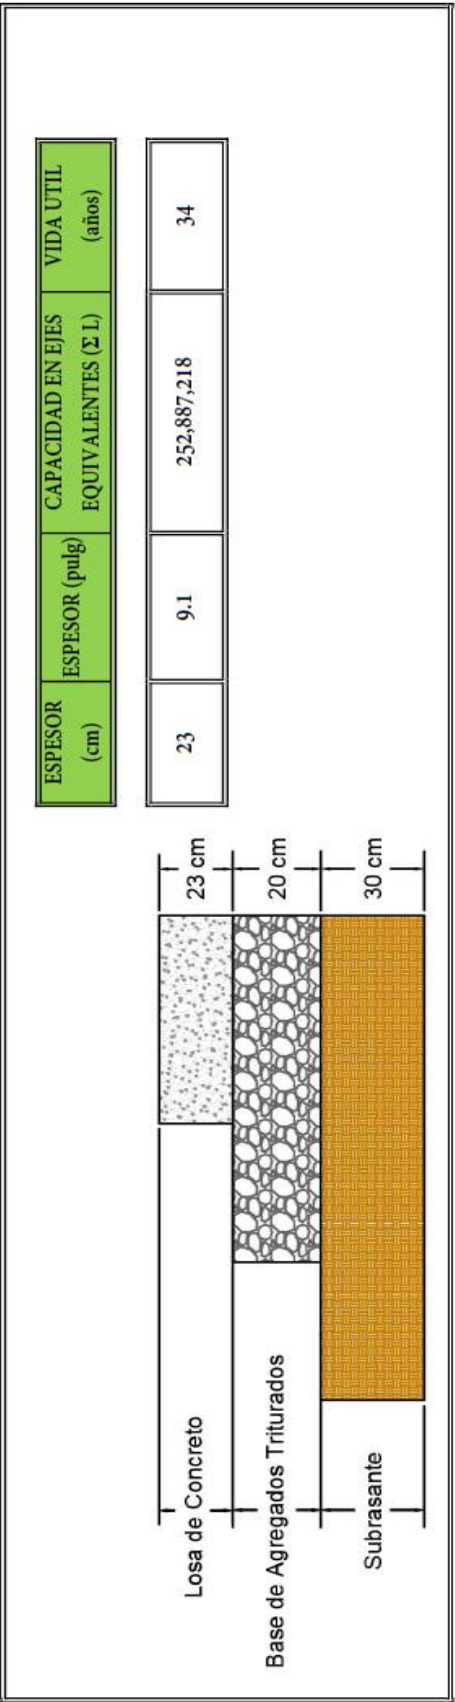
Secciones estructurales del pavimento de concreto por el Método AASTHO
